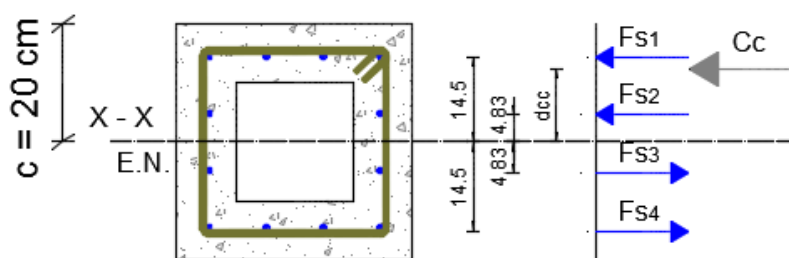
Esquema general de deformaciones, esfuerzos y fuerzas en la sección transversal cuadrada
